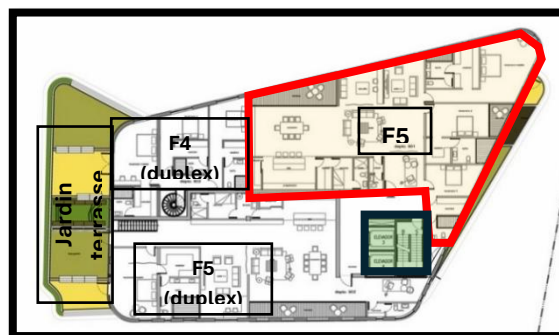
plan R+10 www.archdaily.com traite par les auteurs
